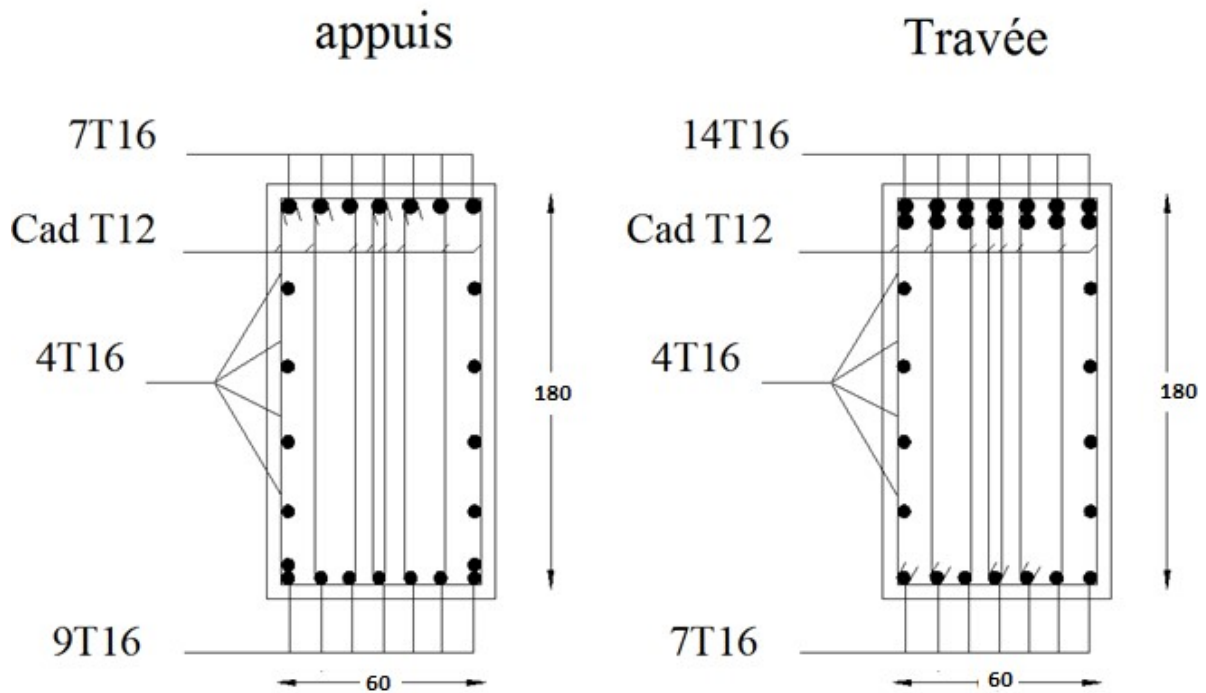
Schéma de ferrailage des nervures (sens porteur)
